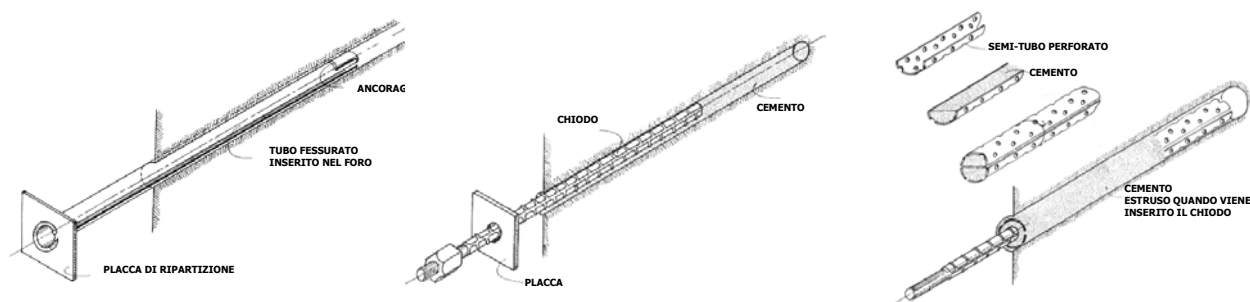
Alcune tipologie di chiodi: a sinistra chiodo in acciaio ad ancoraggio puramente attrittivo (tubi di ancoraggio); al centro chiodo ad ancoraggio per cementazione; a destra chiodo *pefobolt*. In quest'ultimo caso l'ancoraggio è ottenuto tramite cemento inserito in tubi forati posizionati entro i fori di chiodatura; l'inserimento della barra provoca l'estrusione del cemento dai fori e l'ancoraggio del chiodo -
